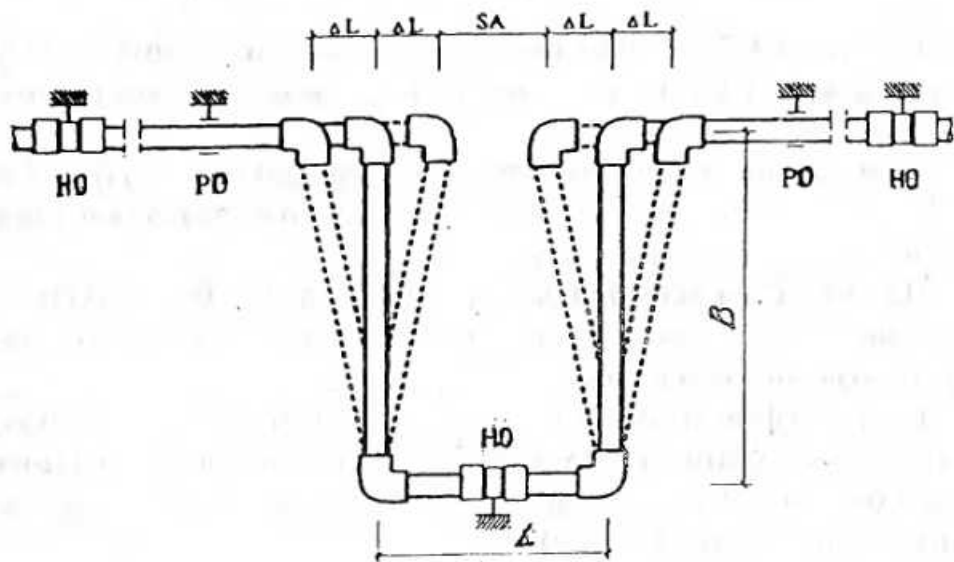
Схема П-подібного компенсатора: РО - рухома опора; НО - нерухома опора; ΔL - теплове видовження прямої ділянки; SA - проміжок безпеки; B - плече компенсатора; L - довжина компенсатора
